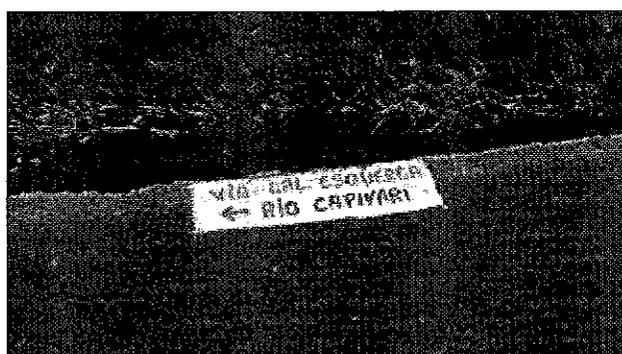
marco a indicar de alteração de projeto para implantação de vias marginais (27°17.47"S 48°58'45.21"W)
